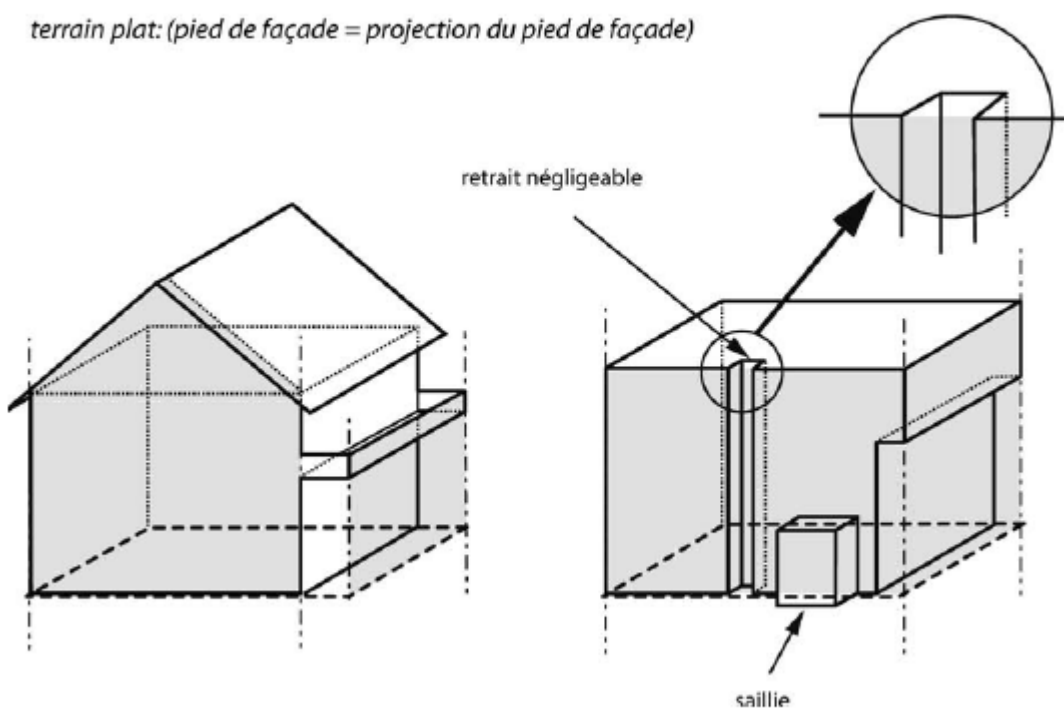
Plan de façade et projection du pied de façade (sur terrain plat)
